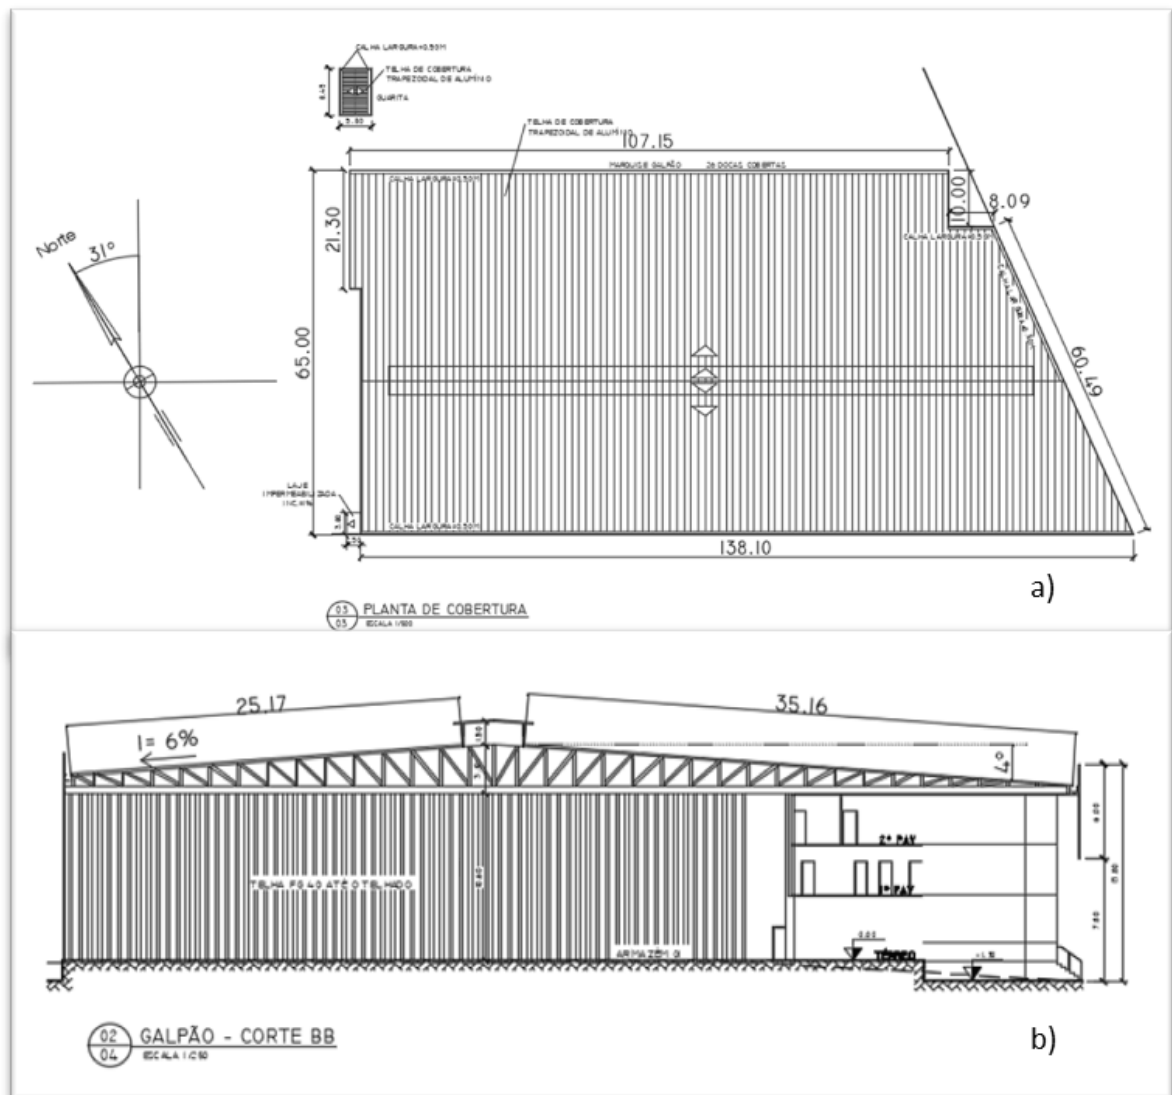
a) Planta de Arquitetura de Cobertura; b) Planta de Arquitetura de Corte.
